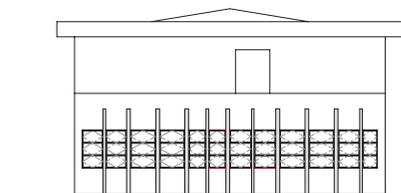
FACHADA LESTE Fonte: desenho da autora.
